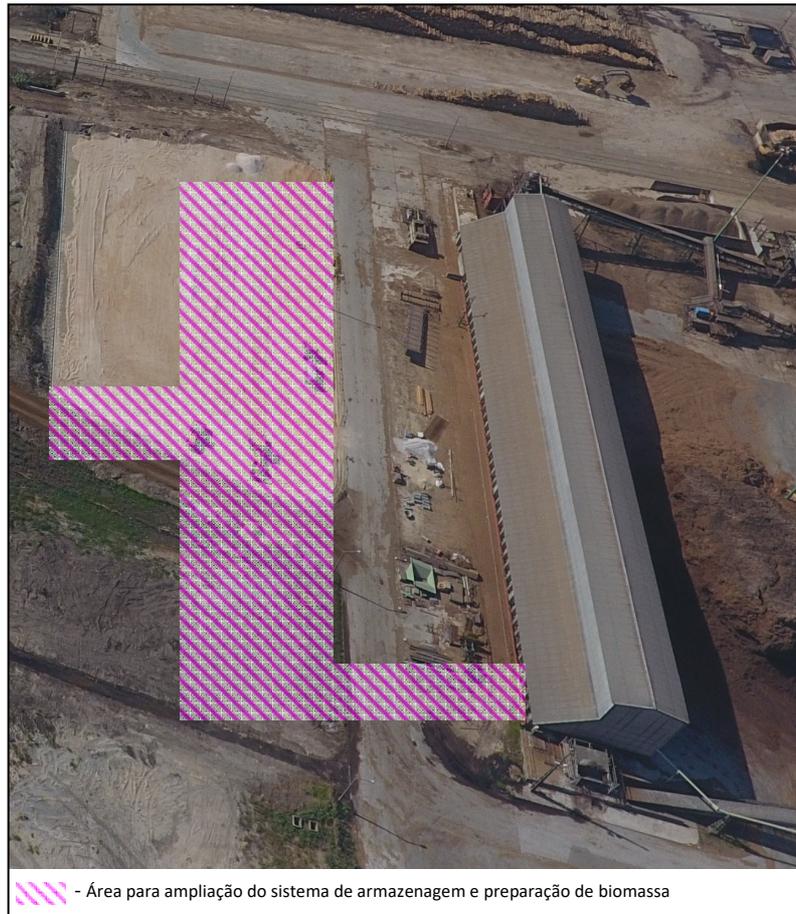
Arruamento existente entre o silo existente e a área de implantação do novo silo
